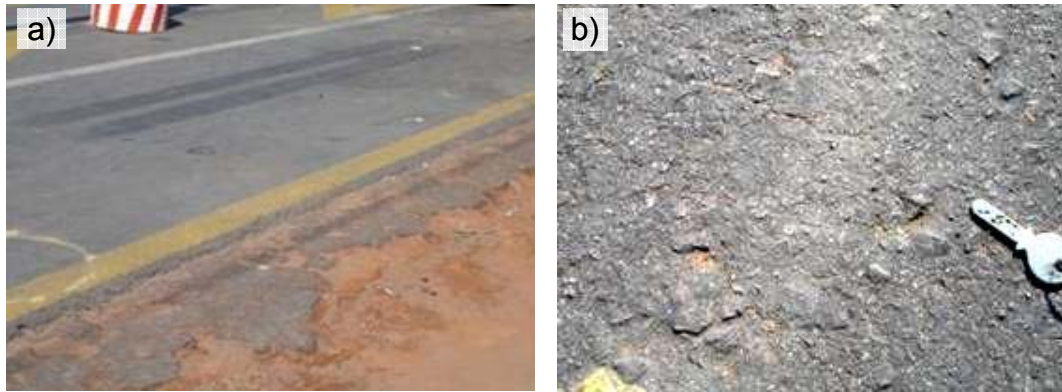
a) Versuchsfeld 1 nach Belastung mit MLS10 mit Reifenspuren; b) Detail mit Rissen in Deckschicht quer zur Fahrtrichtung
